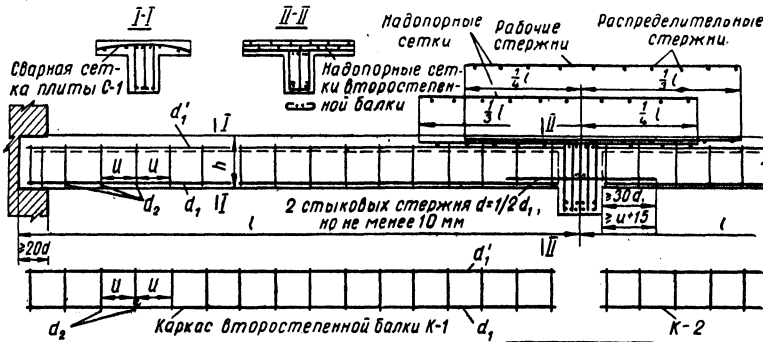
Армирование многопролетной второстепенной балки плоскими сварными каркасами в пролете и сетками на опоре.
